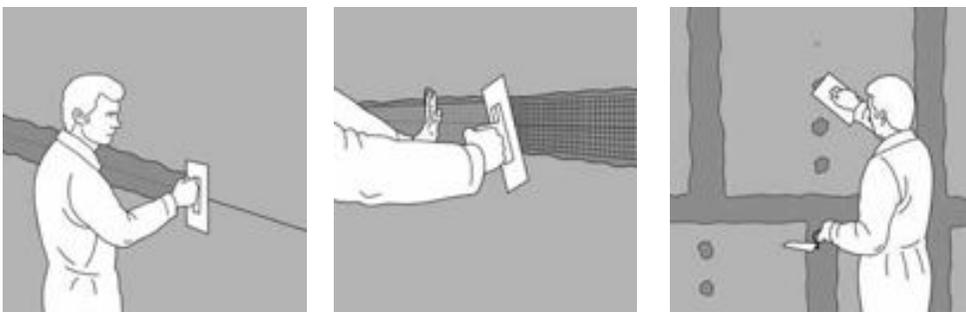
Шпаклевание стыков и мест установки шурупов.
